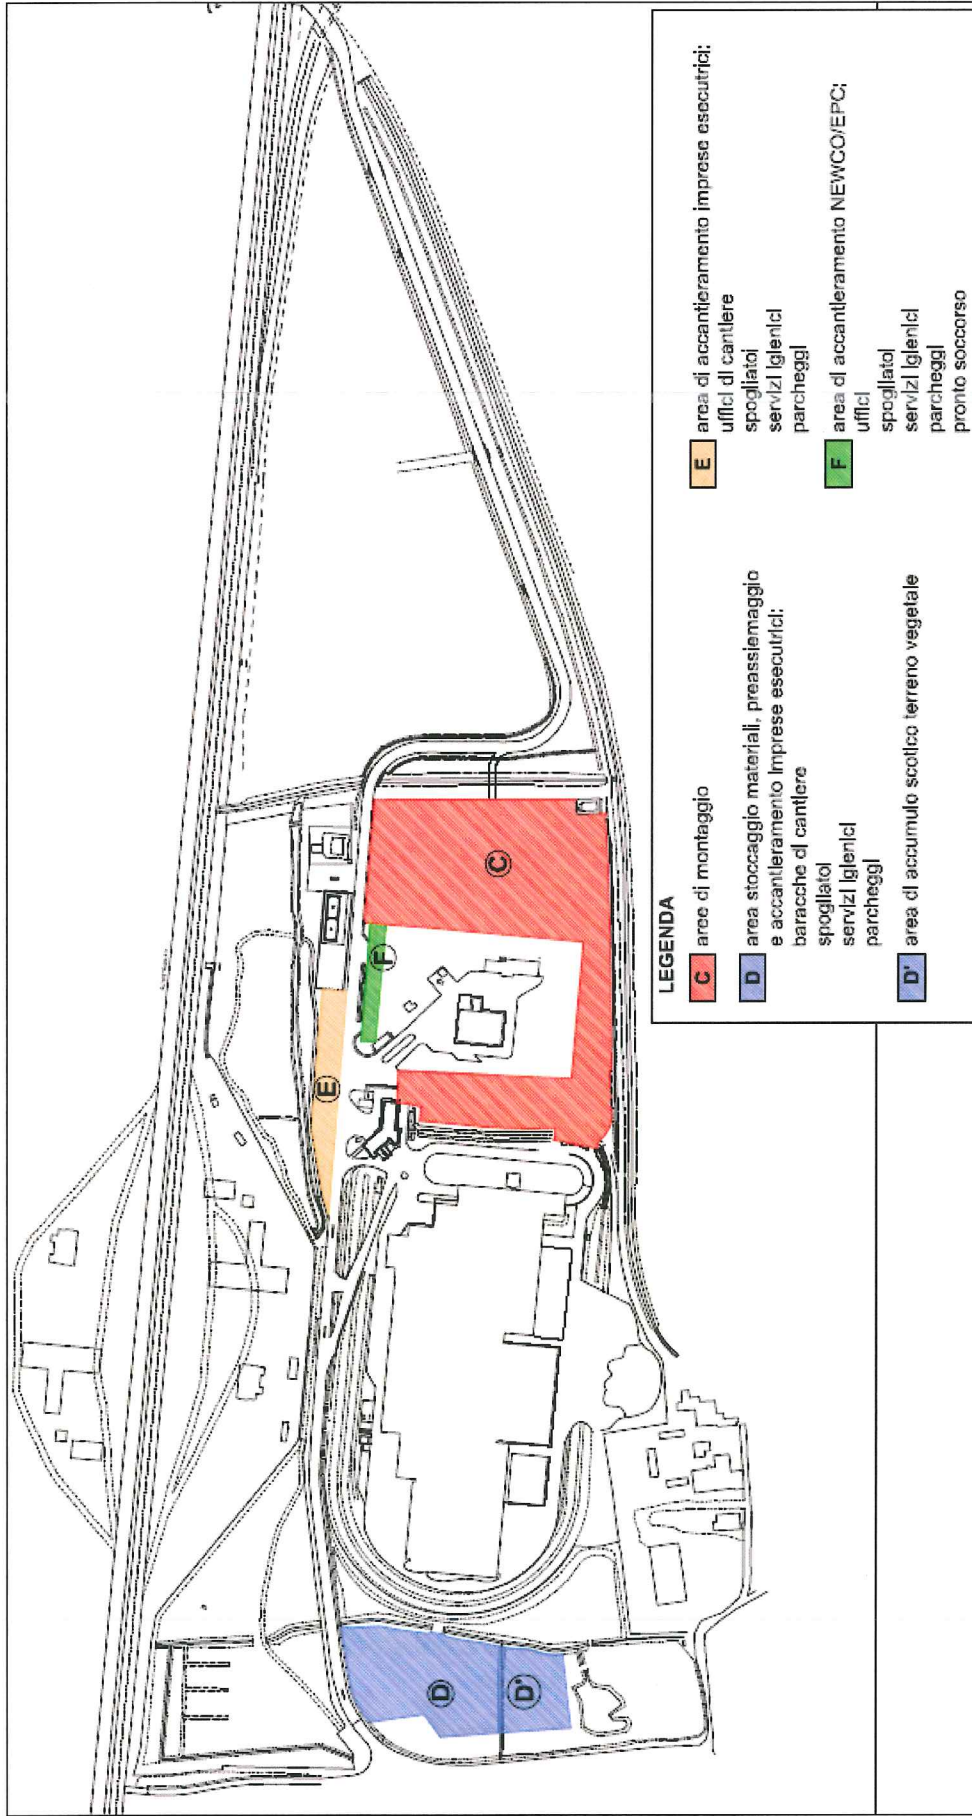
Individuazione aree di cantiere (stralcio della Tavola GEN 010 – Planimetrie aree di cantiere – Aree di cantiere)
